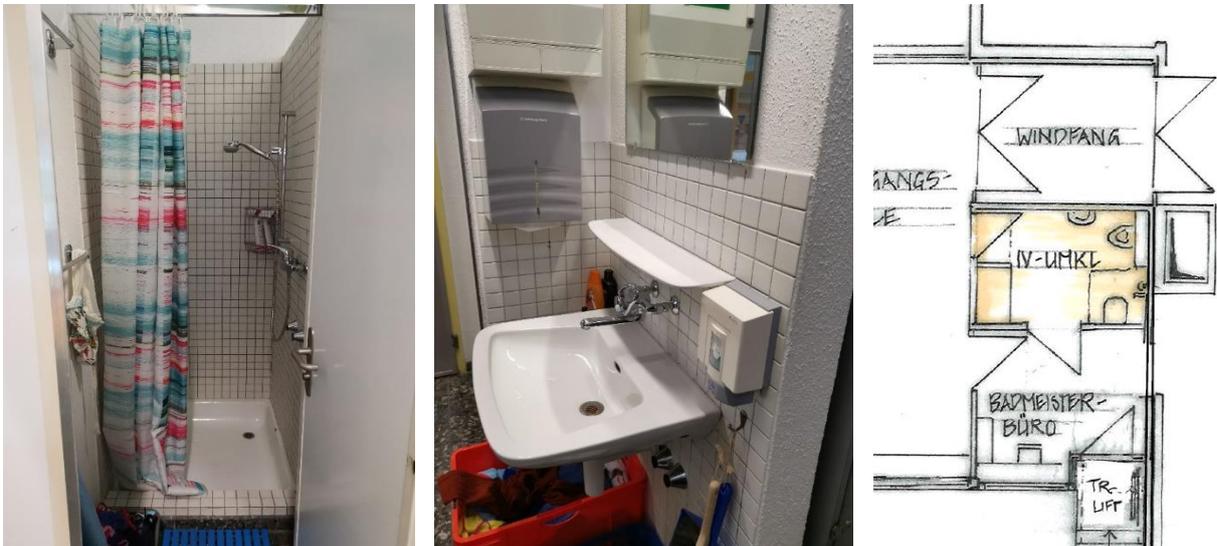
Lehrerbereich/Badmeisterloge, neuer Grundriss inkl. IV Umkleide
